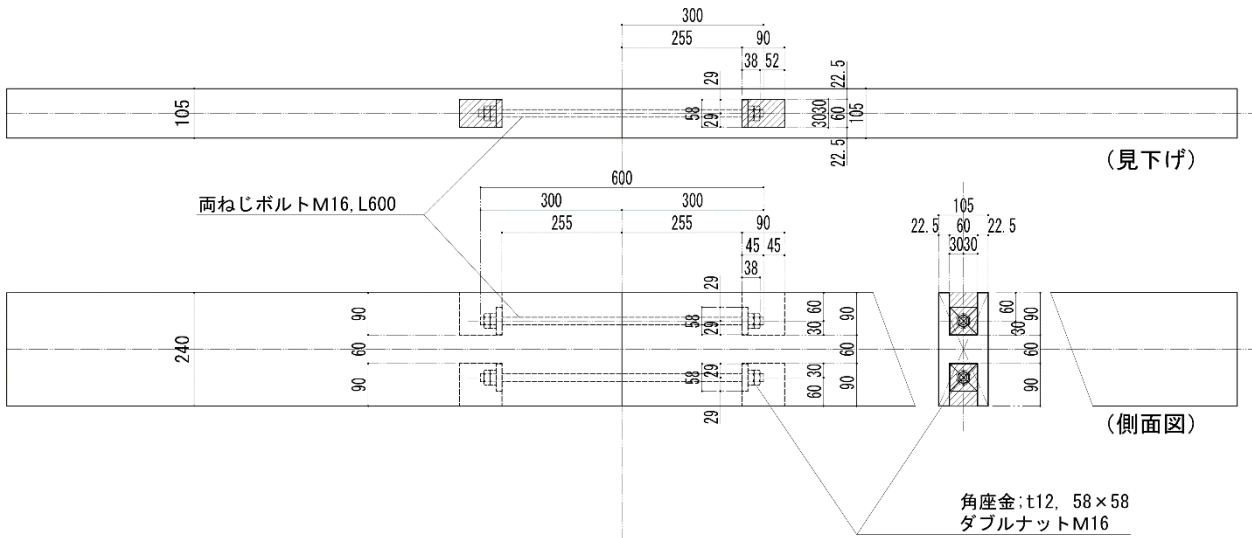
試験体\_No. 15: TBJ-Z600-12/58\_105 試験体
